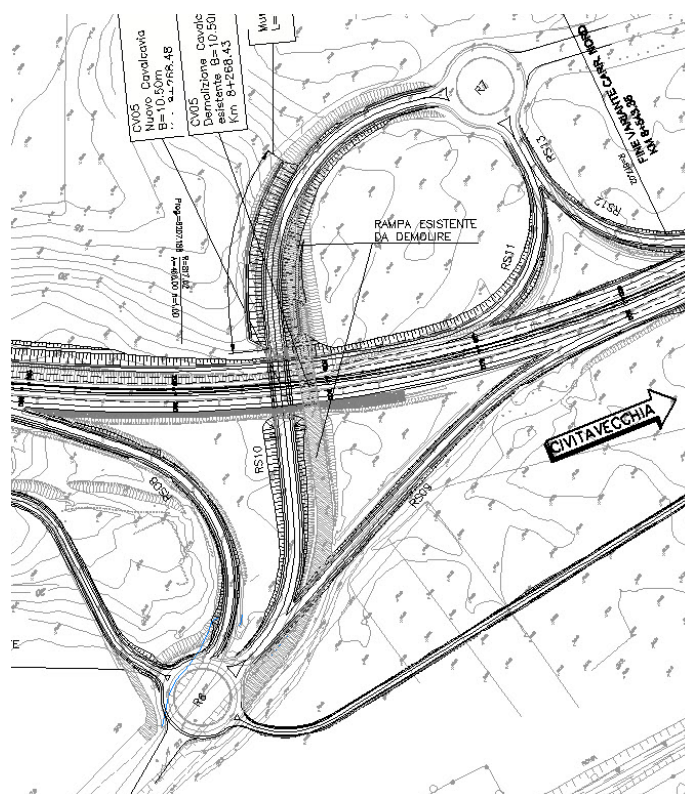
Svincolo Centrale ENEL - Planimetria di progetto
